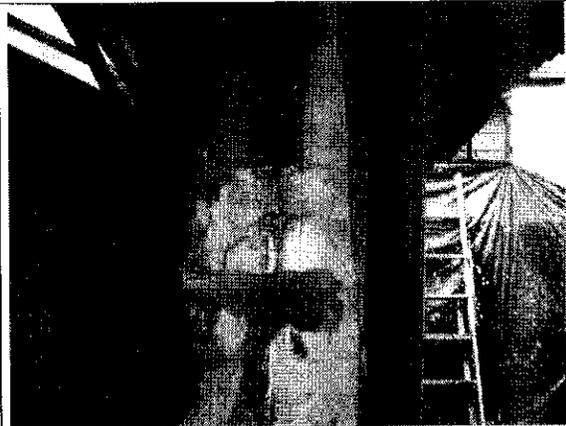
Fisuras en los muros de la zona posterior.
